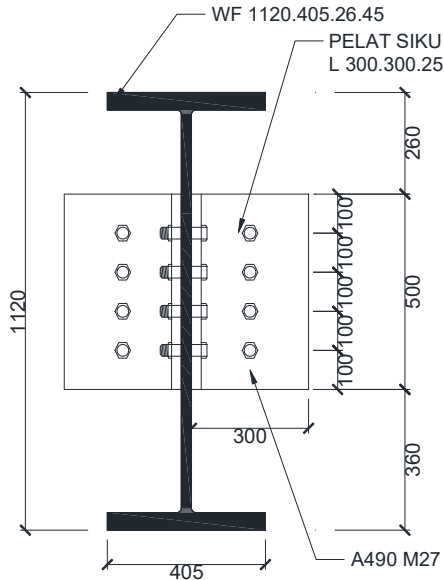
37 Detail sambungan gelagar melintang ke box girder
